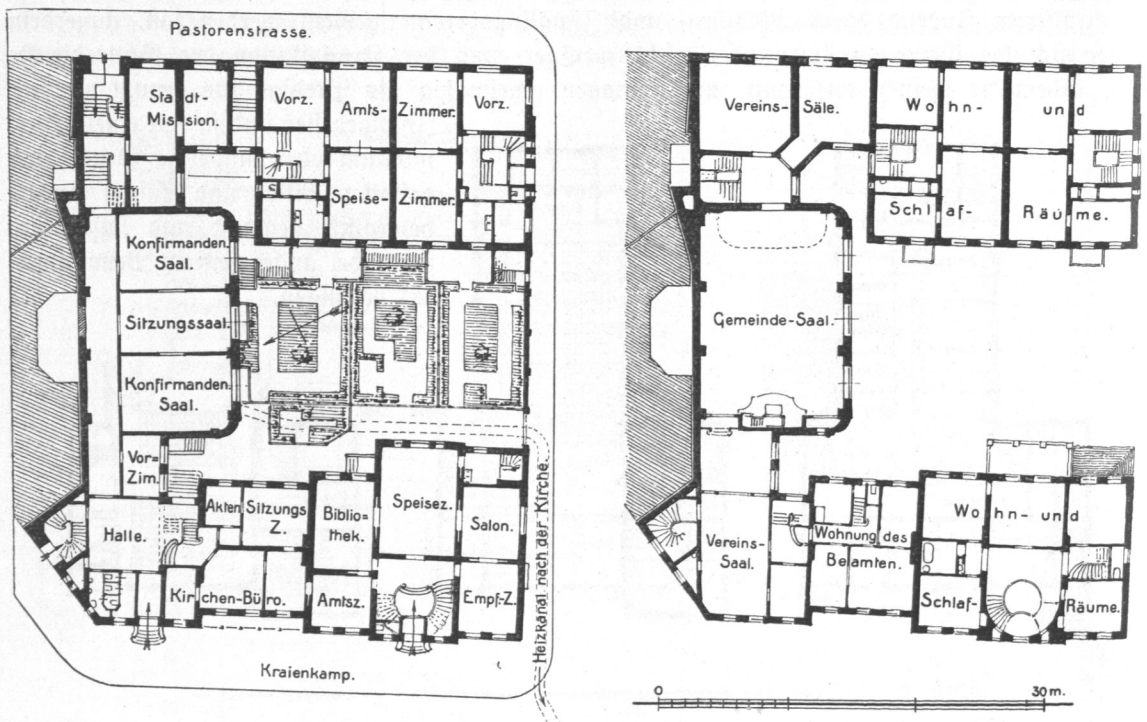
und 168. St.-Michaelis-Pfarrhof, Grundrisse.
